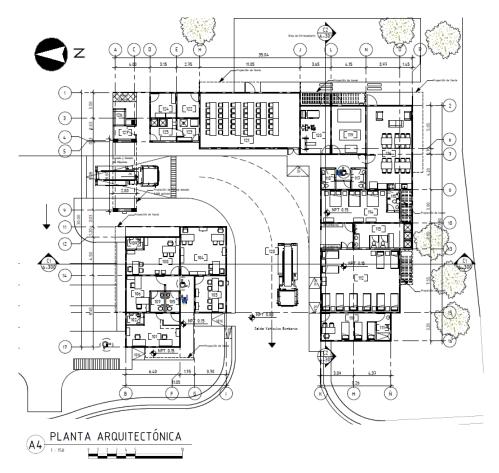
Planta Arquitectónica Estación de Bomberos Potrerillos, Cortés.
